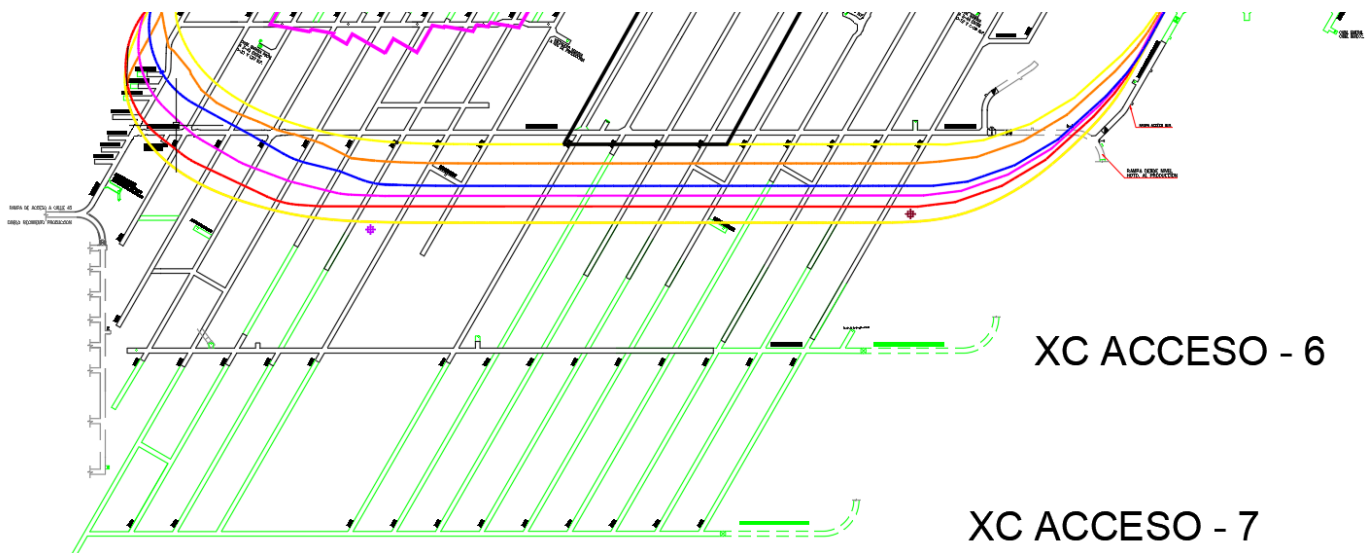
Layout UCL ESM, Desarrollos Verticales (Gerencia de obras mina, 2019)
